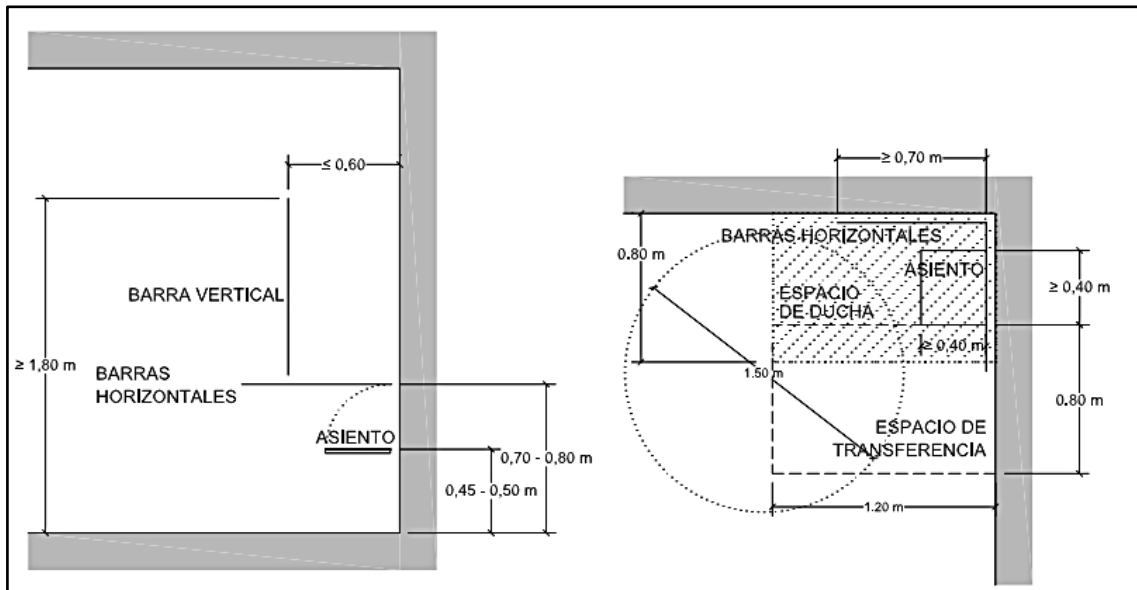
Ejemplo de ducha accesible, alzado y planta.
